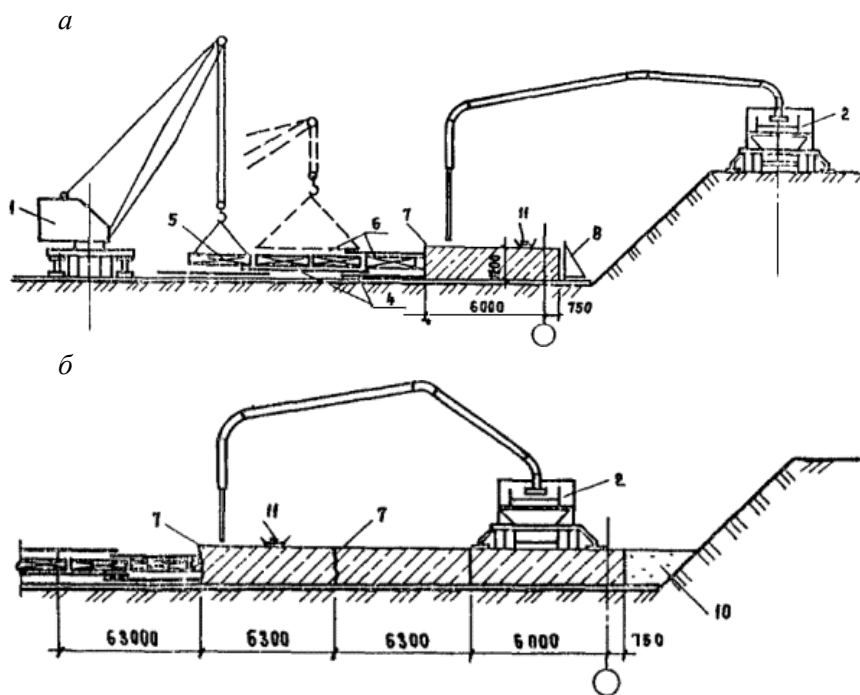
Технологическая схема бетонирования отдельных блоков фундаментной плиты автобетононасосом:
